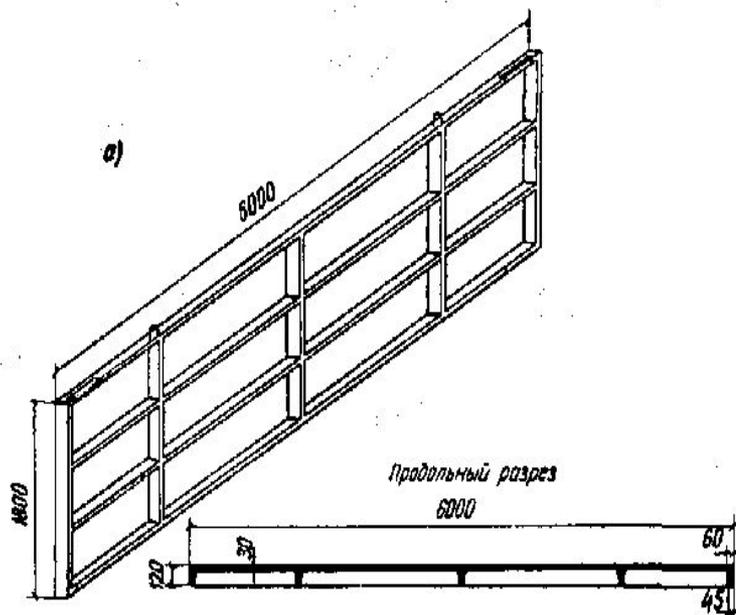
Железобетонные ребристые панели для стен неотопливаемых зданий
